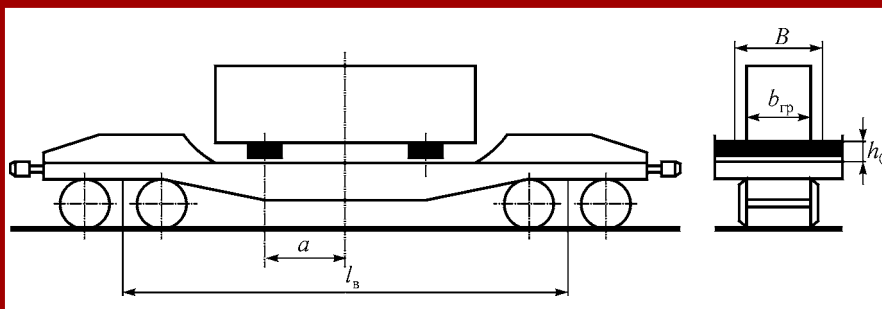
Схема расположения поперечных подкладок на платформе
